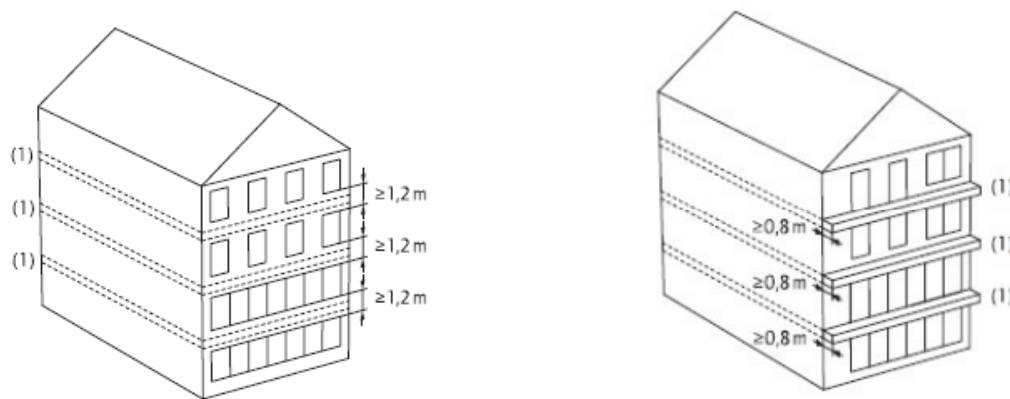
Maßnahmen zur Begrenzung der vertikalen Brandausbreitung bei brandabschnittsbildenden Decken
